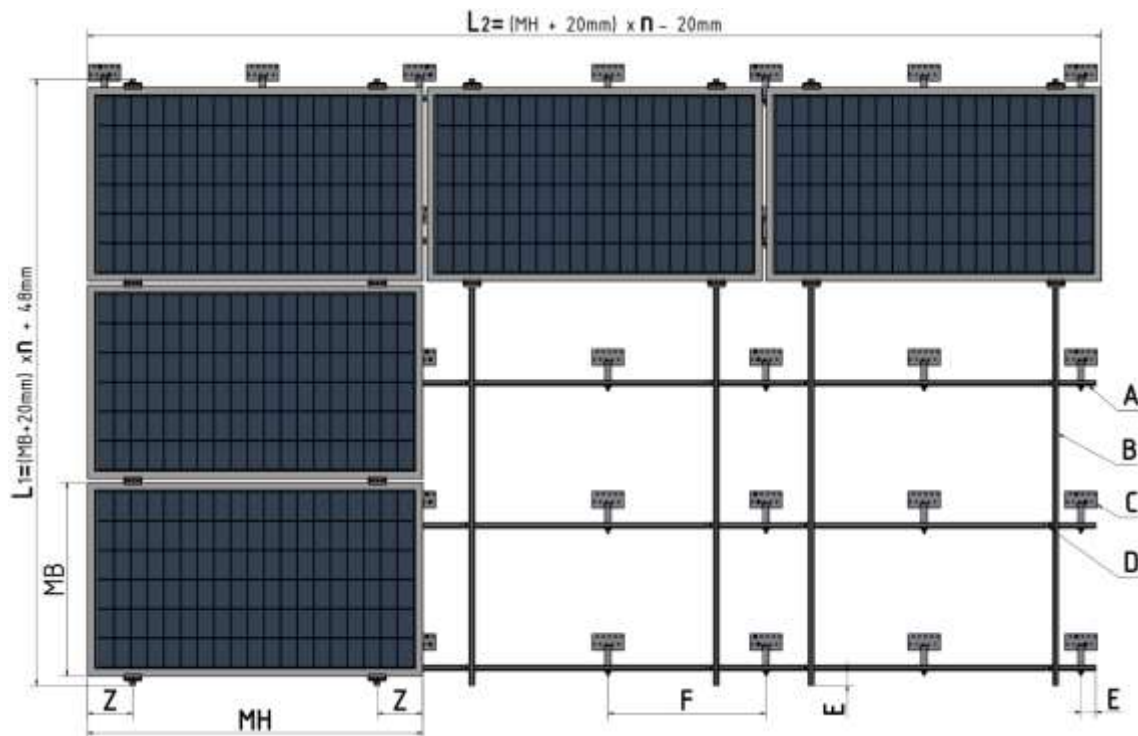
Dachhakenverbinder und Trägerprofil im Gesamtbild
